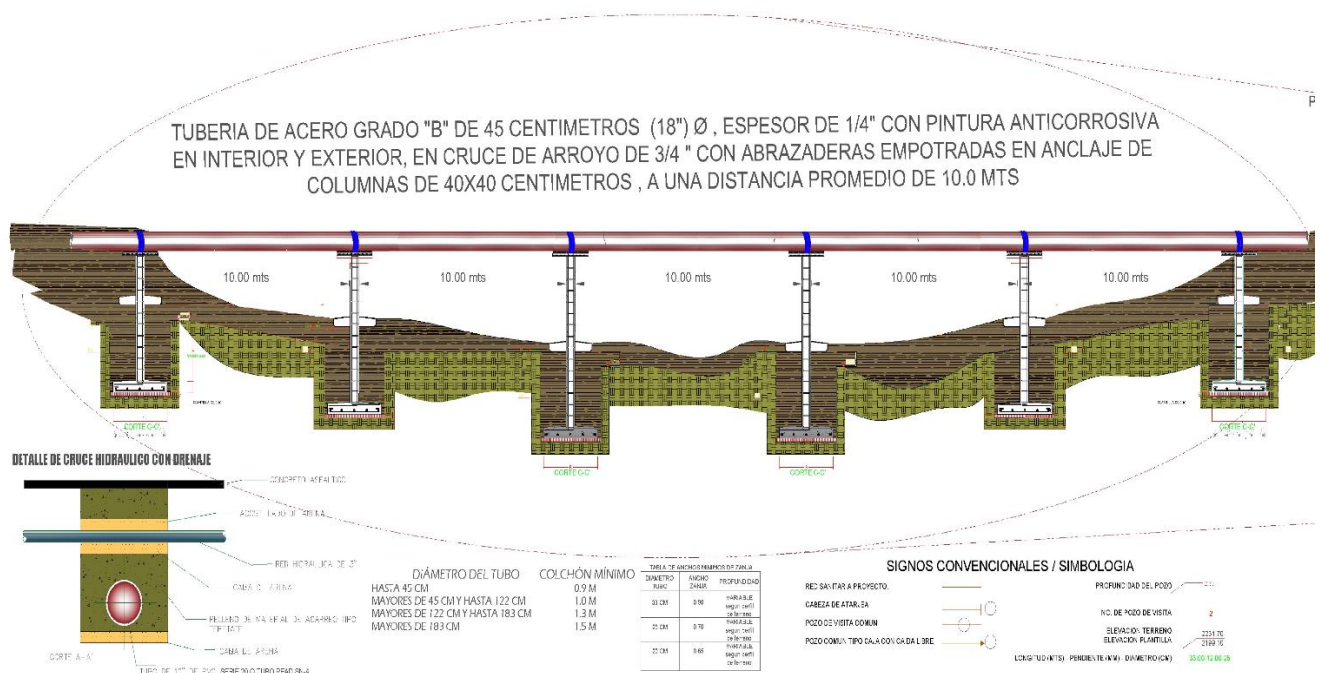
DISEÑO DE LA CONSTRUCCIÓN DEL PASO ELEVADO DE TUBERÍA
